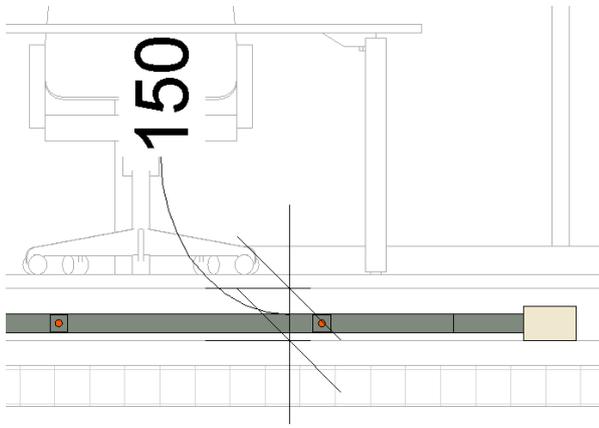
Posa del condotto sbarre e altezza del pavimento flottante
